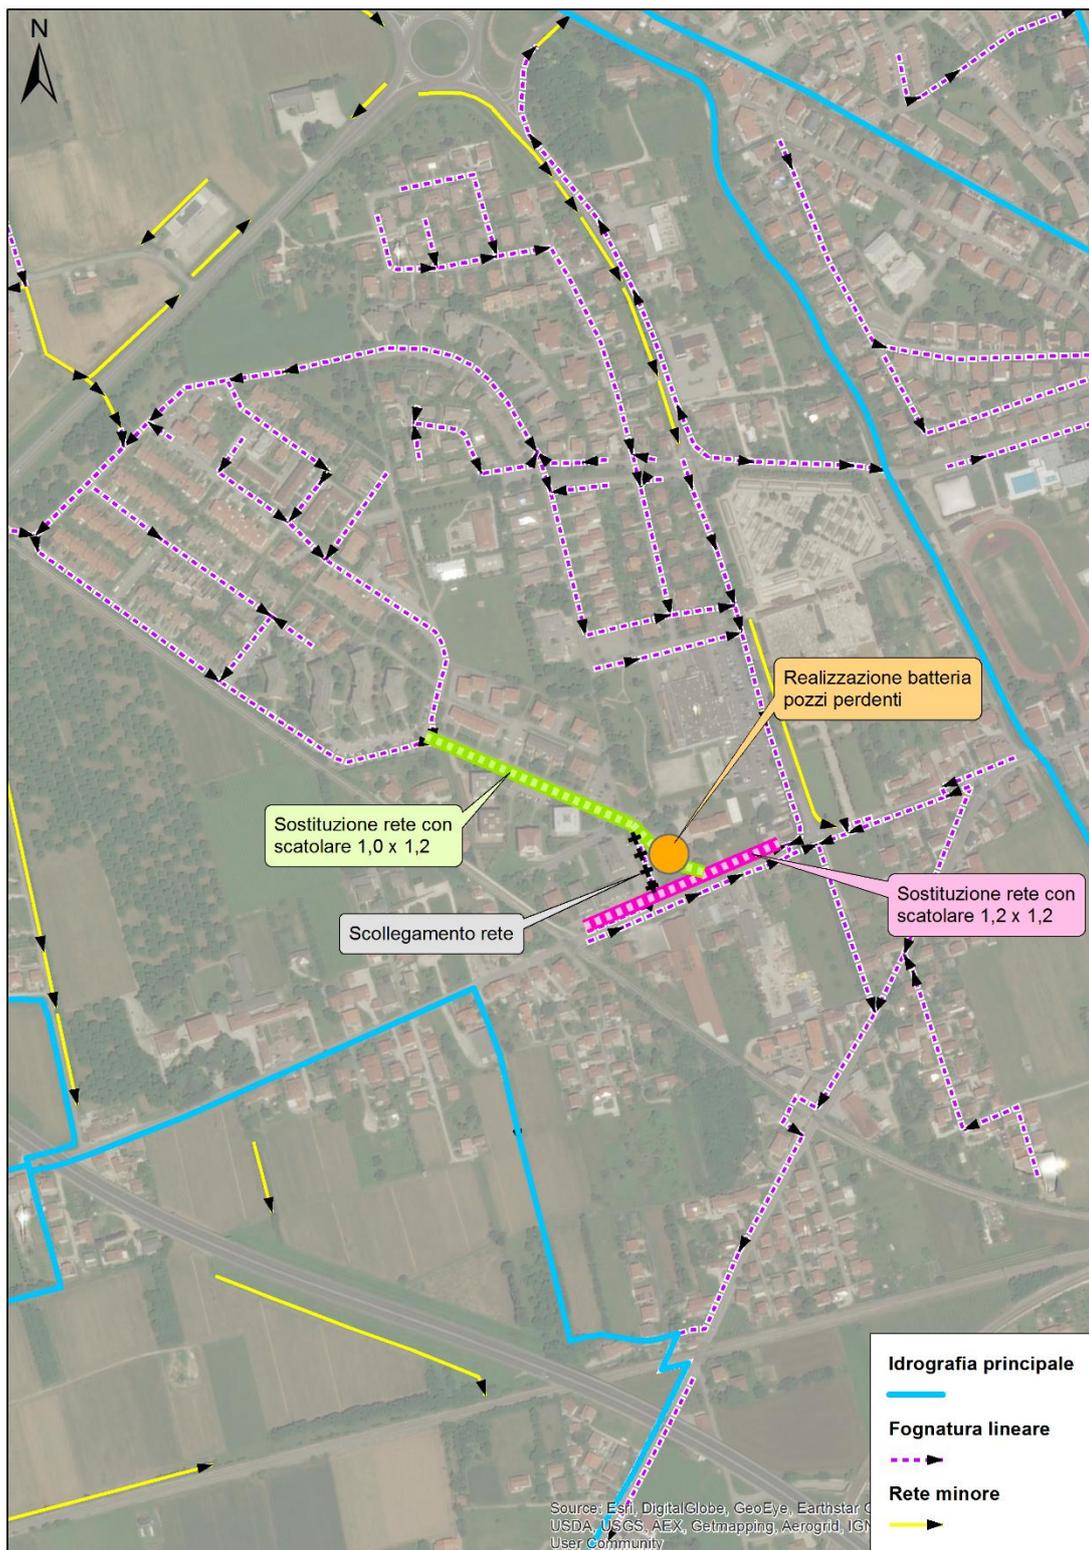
Rappresentazione delle proposte progettuali previste nello stato di progetto
